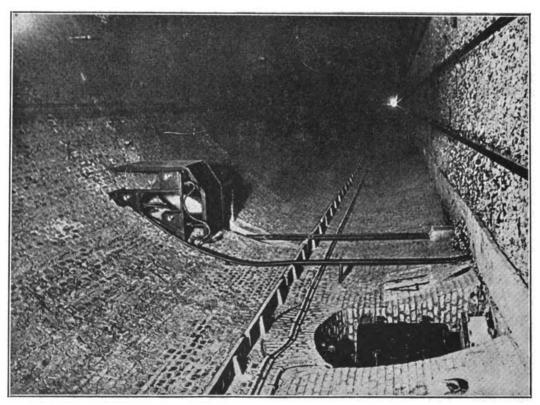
Segnale di protezione di stazione in galleria e nicohia con apparecchi del blocco.
